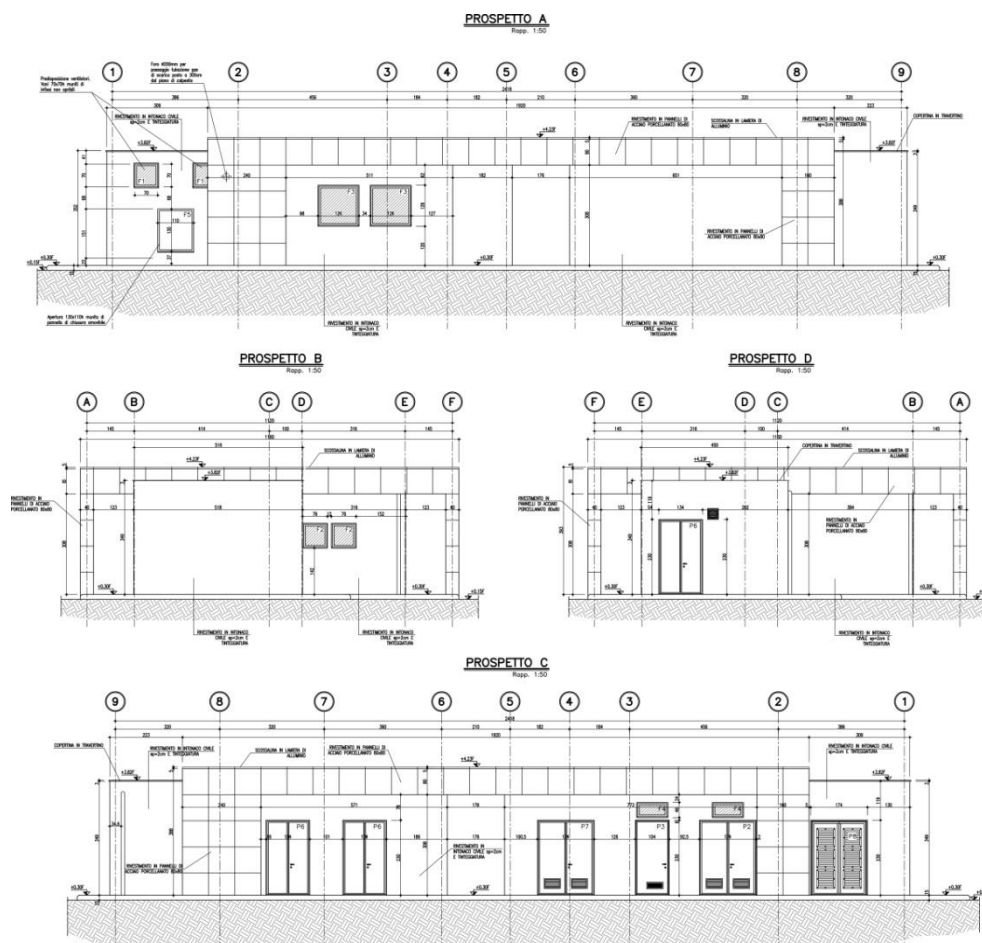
È Fabbricato di stazione ed impianti - Pianta e Prospetti
